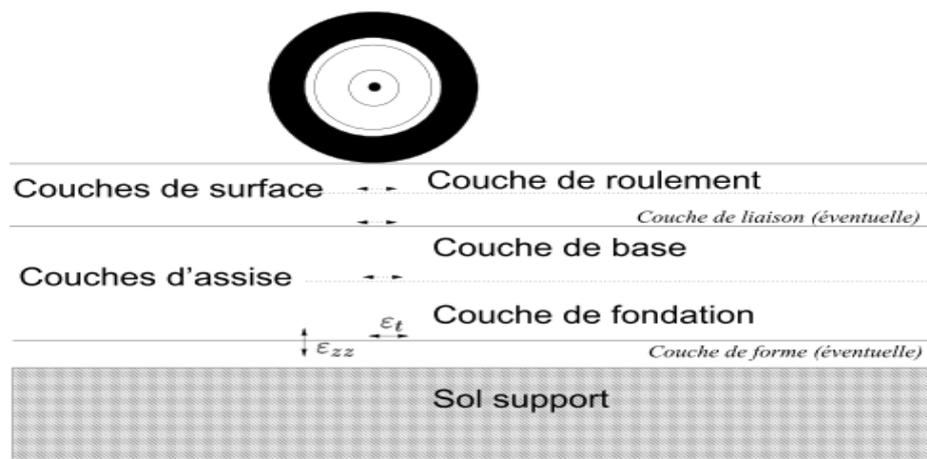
Coupe schématique d'une chaussée (Bodin, 2002)
